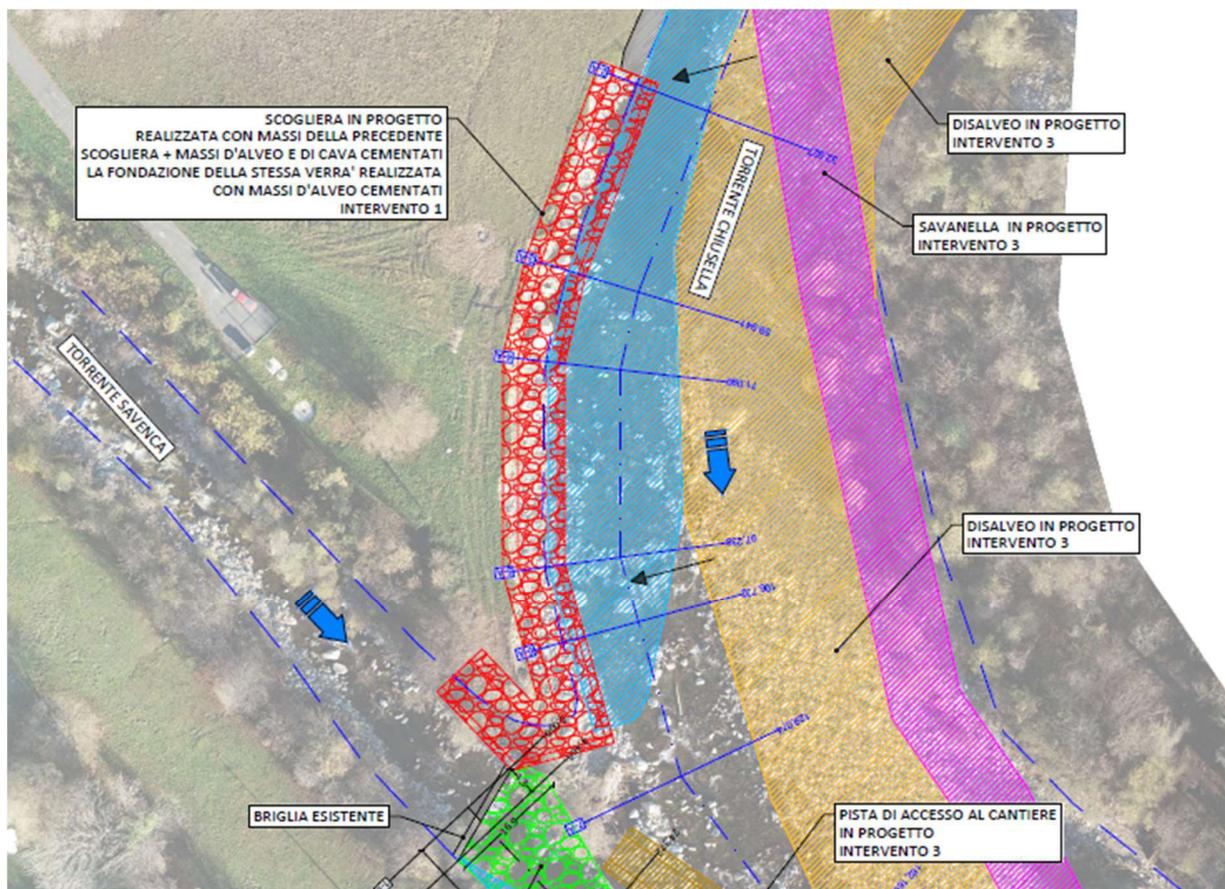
Planimetria progetto approvata nel progetto definitivo – Scogliera in progetto in rosso
